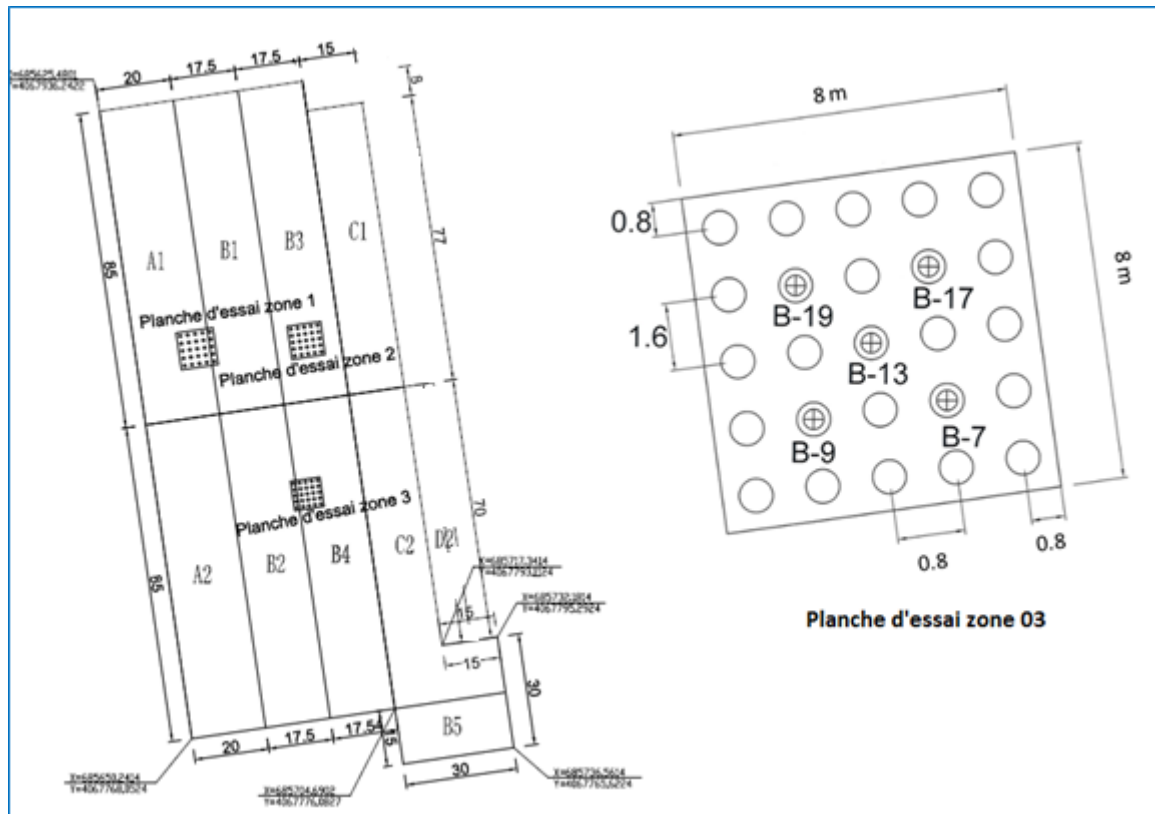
Disposition des planches d'essais et détails de la planche N°03
